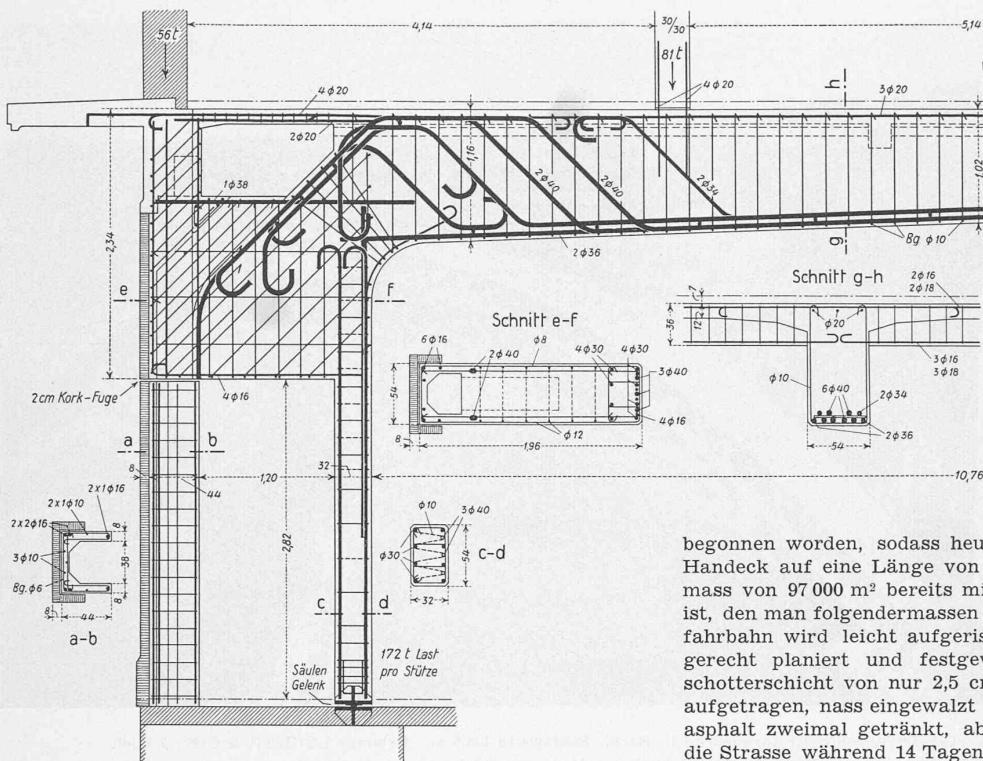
Eisenbeton-Binder im Erdgeschoss, 1 : 60.
